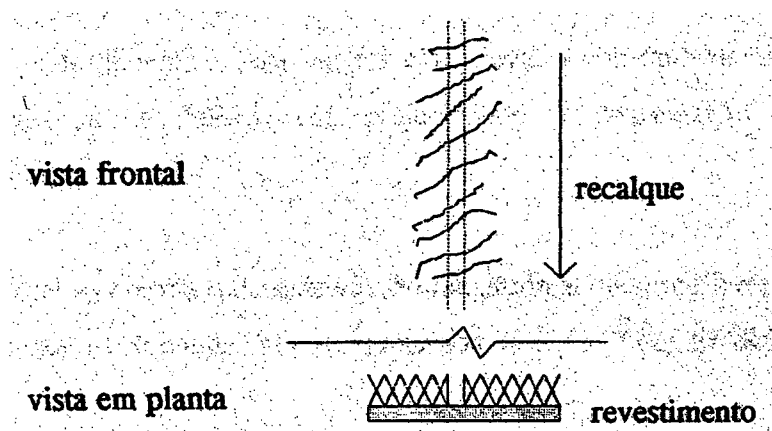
Fissuras por esforços de tração, decorrentes do cisalhamento de um revestimento aplicado sobre uma junta de assentamento (JOISEL, 1981)
